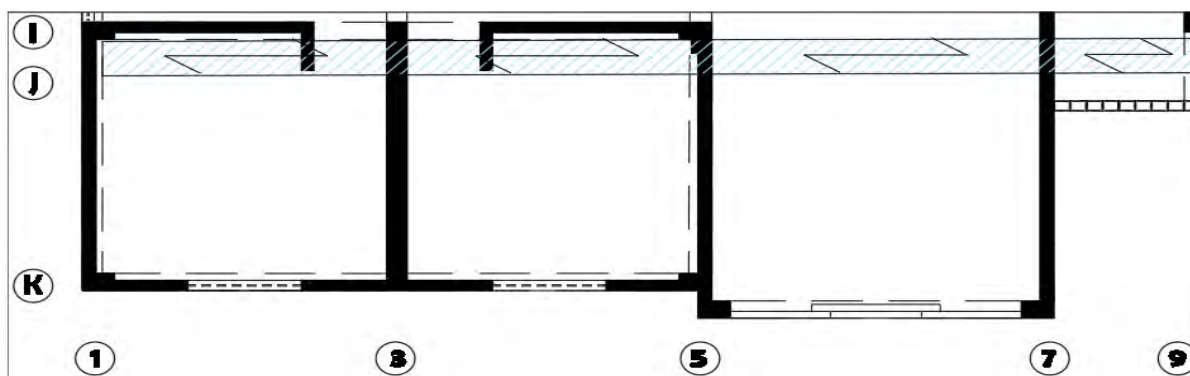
Ejemplo de Aligerado en planta de Arquitectura
